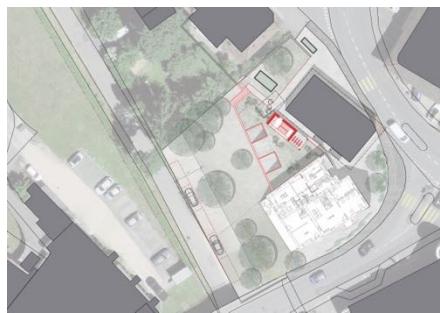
Variante mit Kleinbaute als Zugang und Längsparkierung im Stadtgraben
